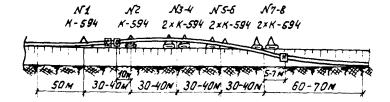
Размещение механизмов в колонне при укладке трубопровода Ø 1420 мм в условиях неустойчивых грунтов
